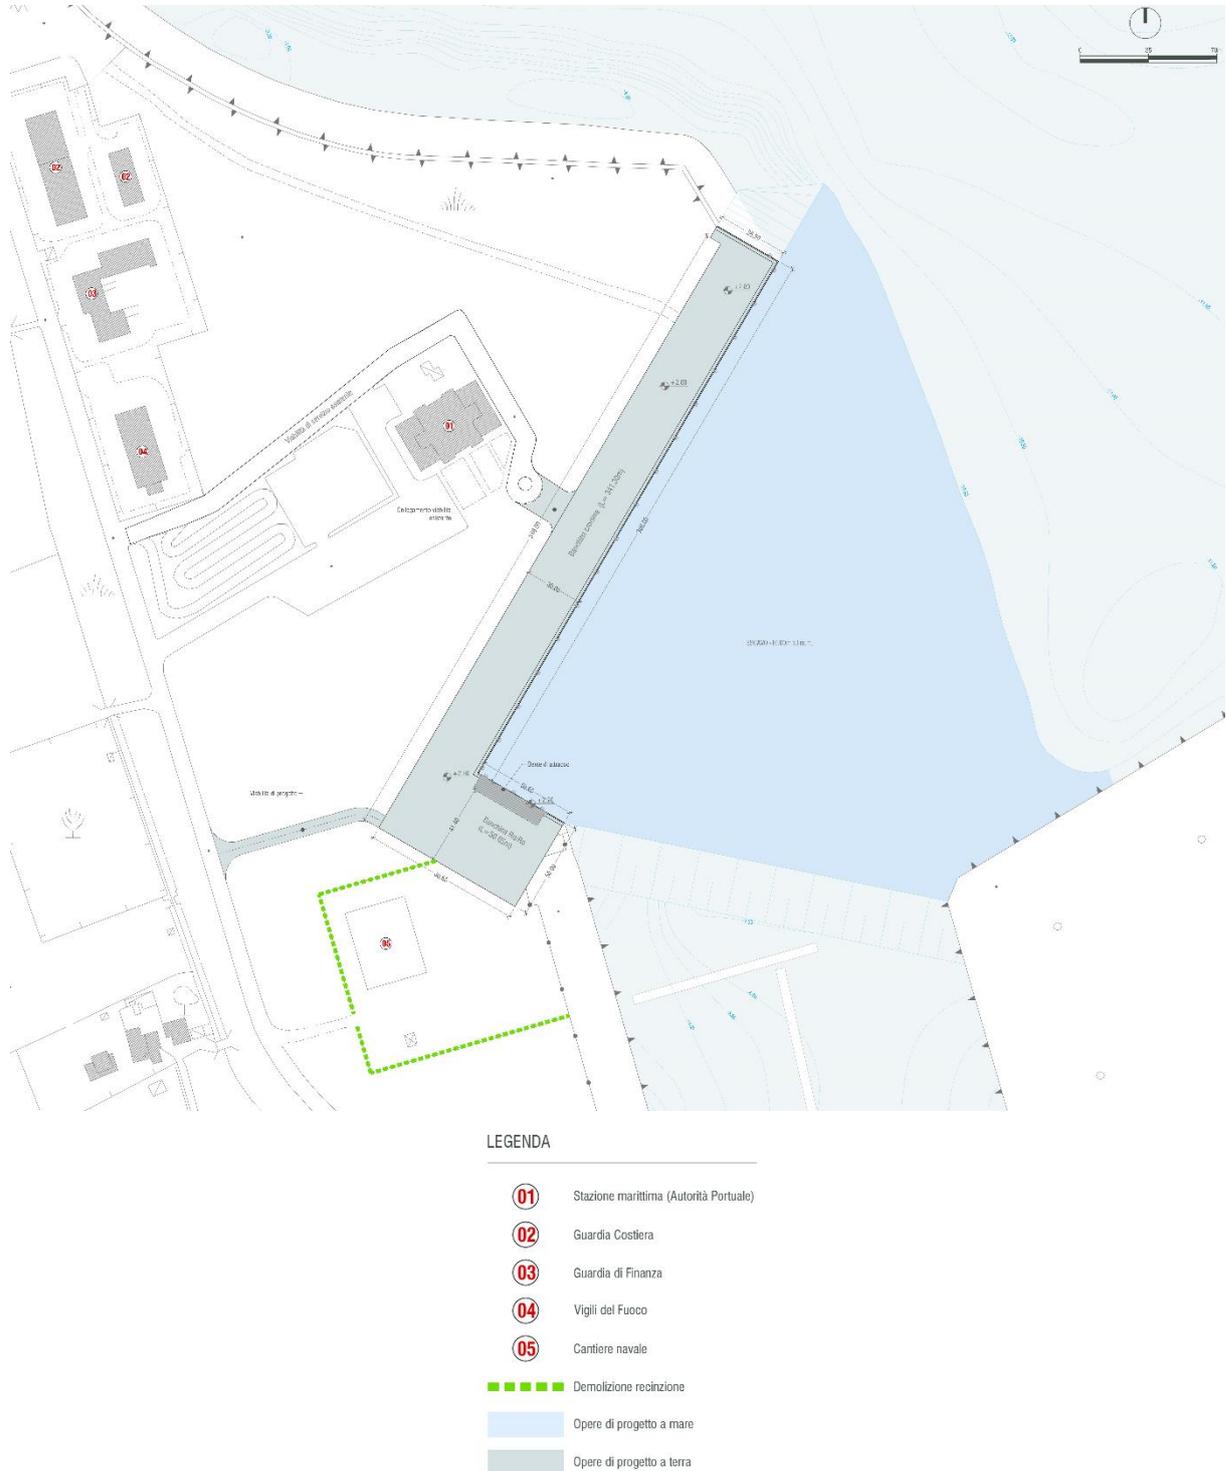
Planimetria di opere di progetto (Elab. EG.08)
